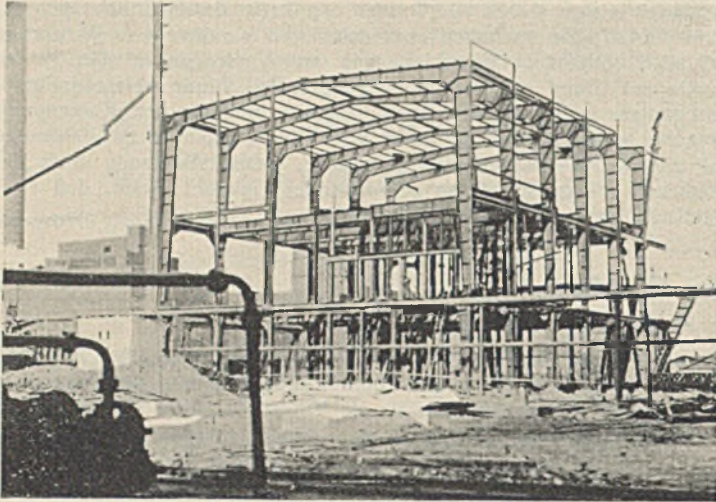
Geschweißte mehrstöckige Vollwandrahmen; Wippelle einer Kohlenzeche.
